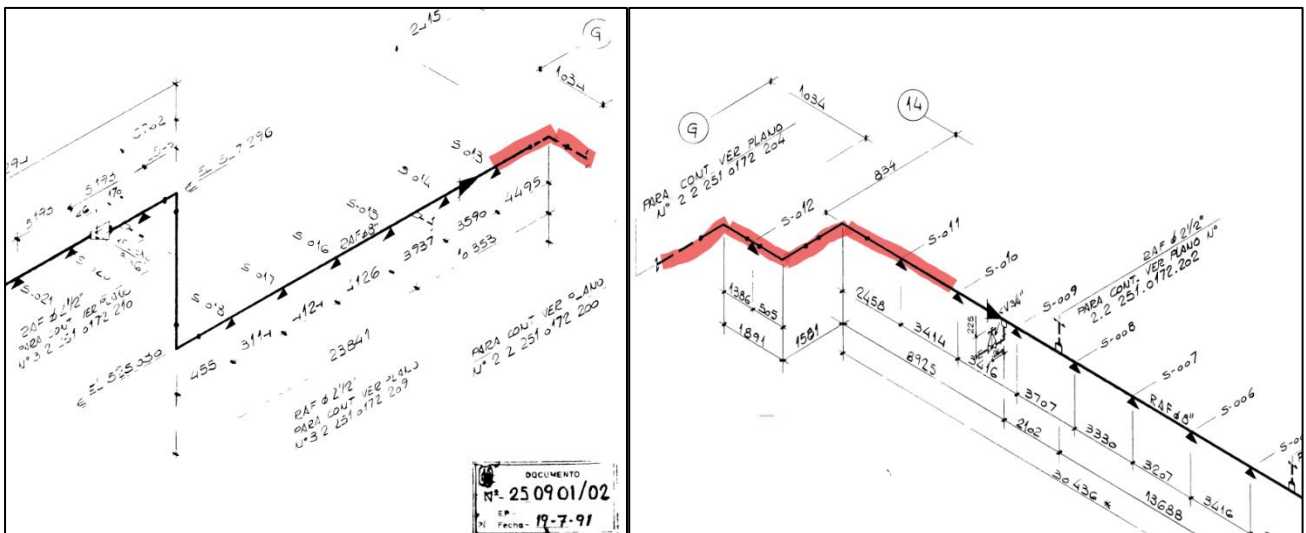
Extracto de planos 25.09.01-2 y 25.09.10-89a con detalle tramo aproximado a cortar para tubería 8".
